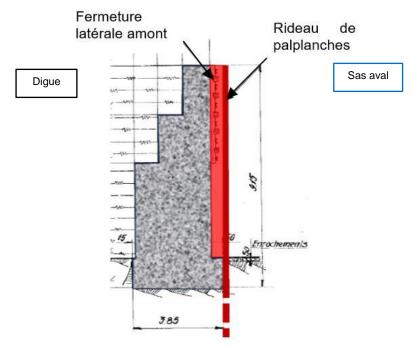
Schéma de principe du rideau de palplanches durant les travaux- vue en coupe (Source : EDF)
